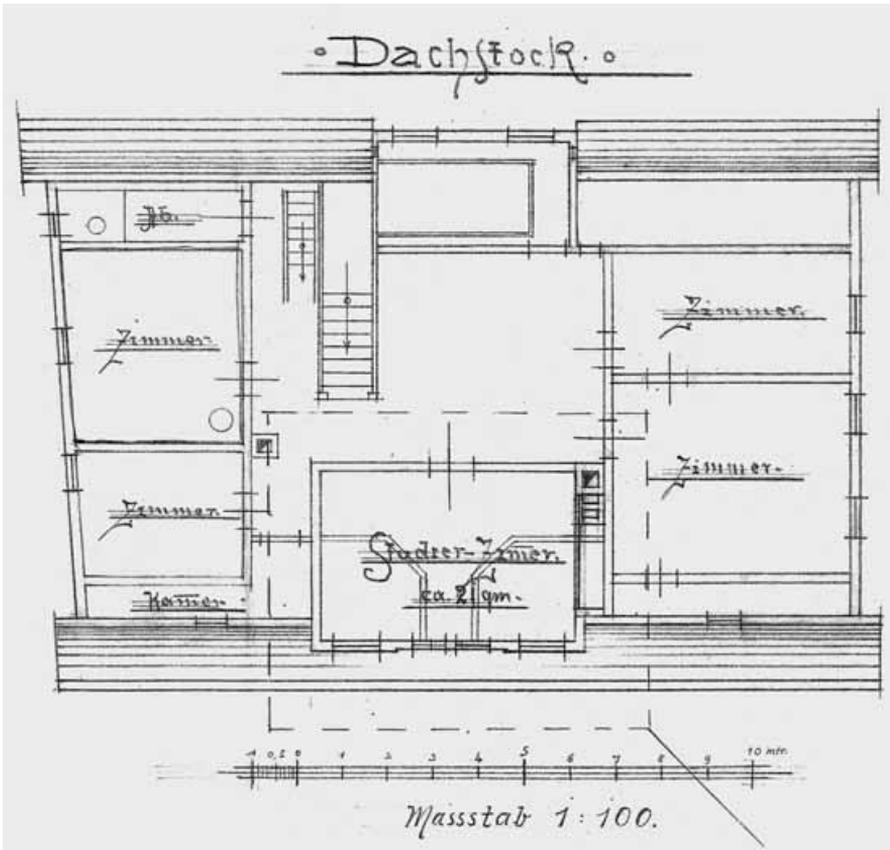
Metzgerstraße 56, Grundriss 1. Dachgeschoss, Umbauplanung von 1916/17 (s. gestrichelte Linie) mit Einzeichnung des früheren Bestandes (kleine Gaube) im Bereich der großen Gaube nach Süden; vgl. Abb. 10.
